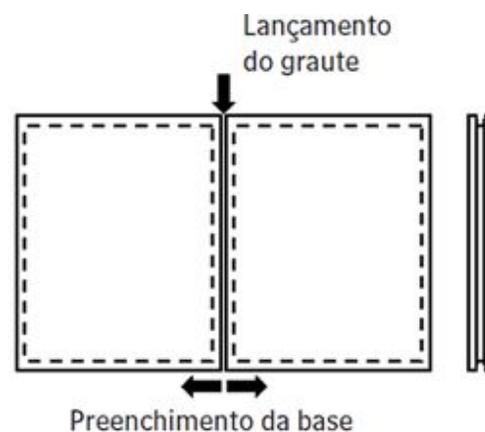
Grauteamento da ligação lateral e da base dos painéis
